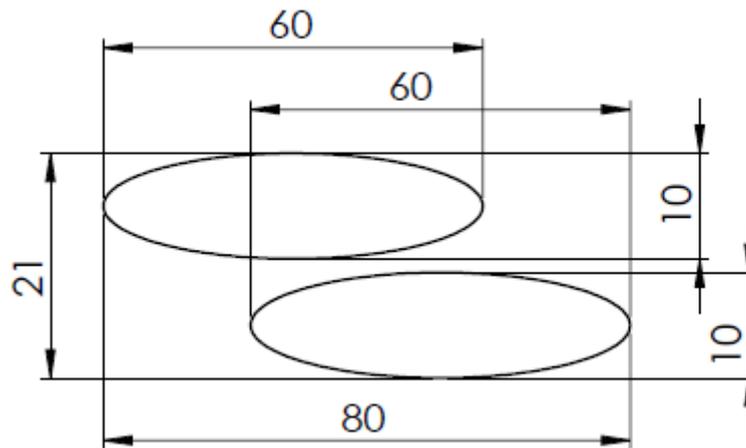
Ejemplo de sección dócil de un elemento formado por dos tubos
